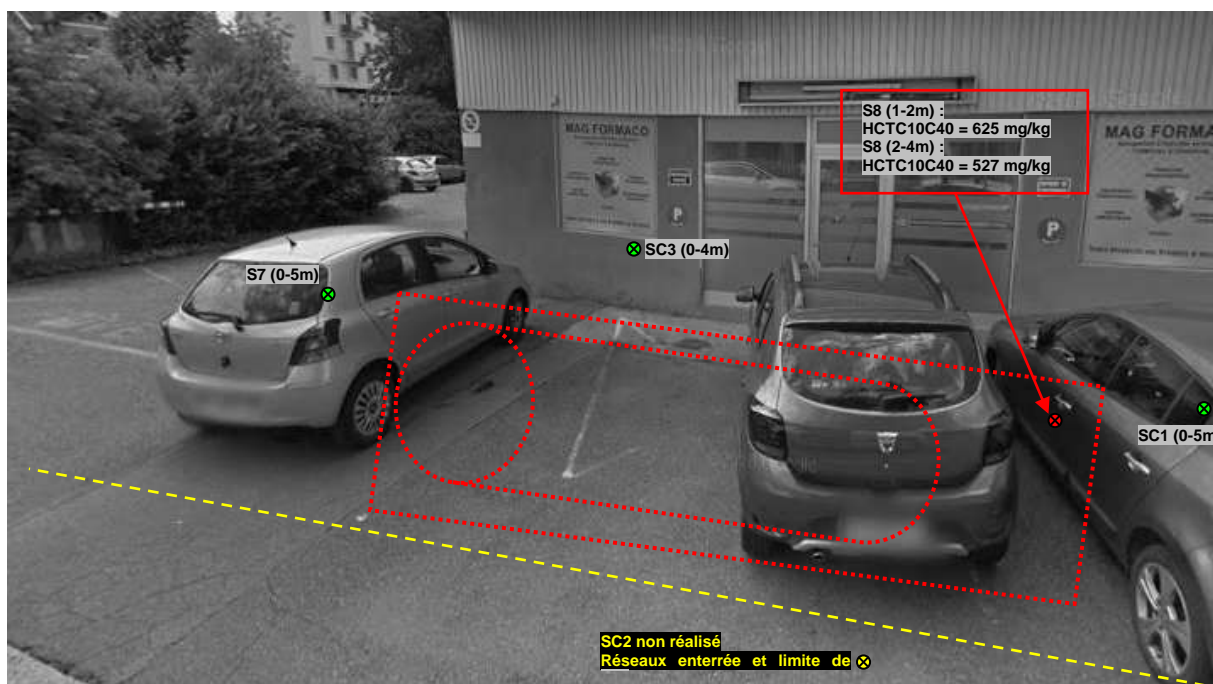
Zone HCT non inerte 1 – 4, Boulevard de Savoie, parcelle 339
